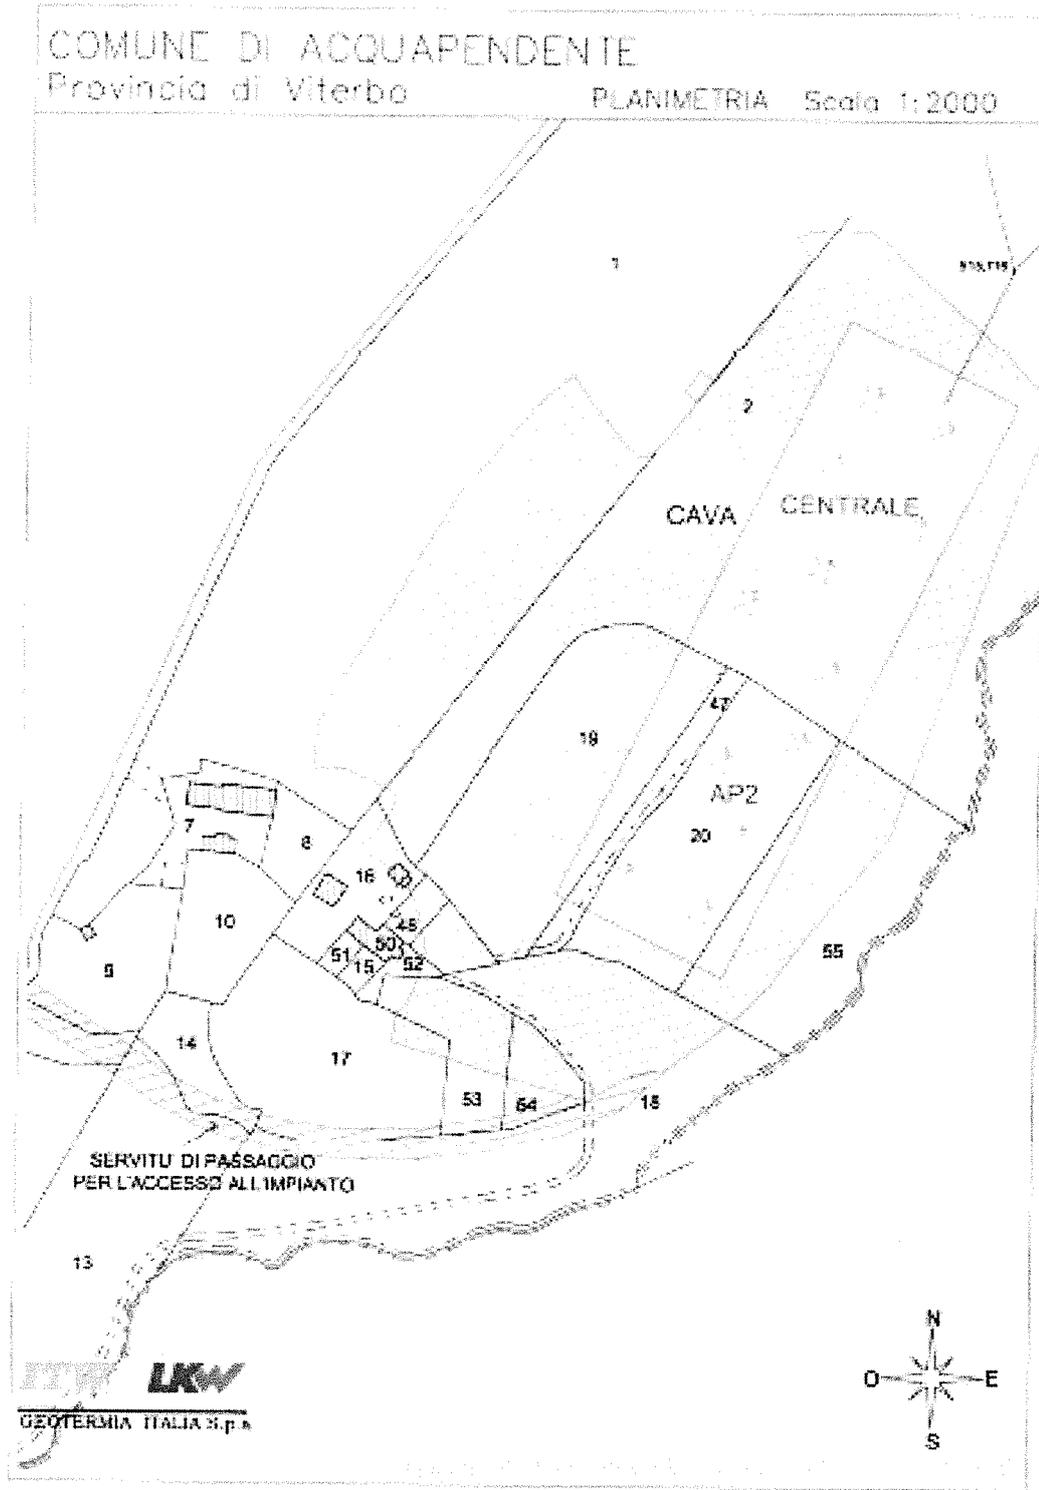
Planimetria della postazione AP2 e dell'impianto ORC con l'indicazione dei punti di sondaggio
